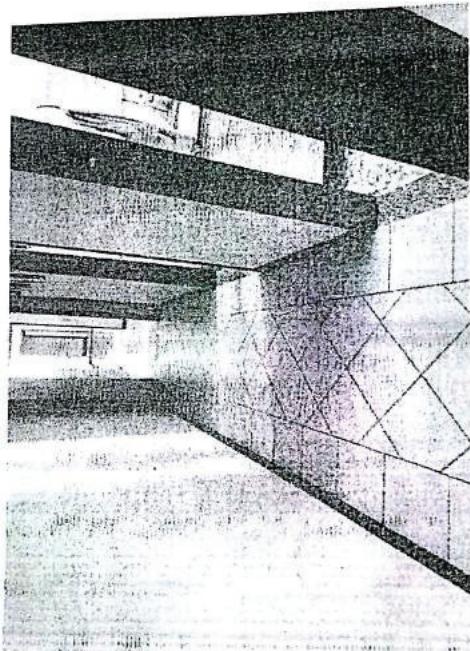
VISTA CORREDOR - IMÓVEL 02
